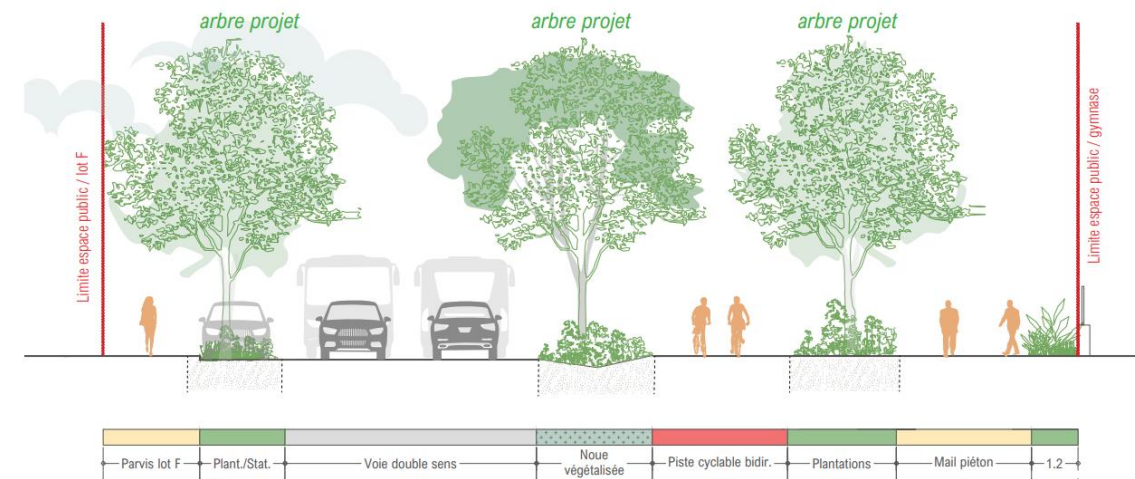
Plan de coupe de la section Est de la Voie Nouvelle, au contact du mail piéton, après projet (La Fabrique Urbaine, 2025)
